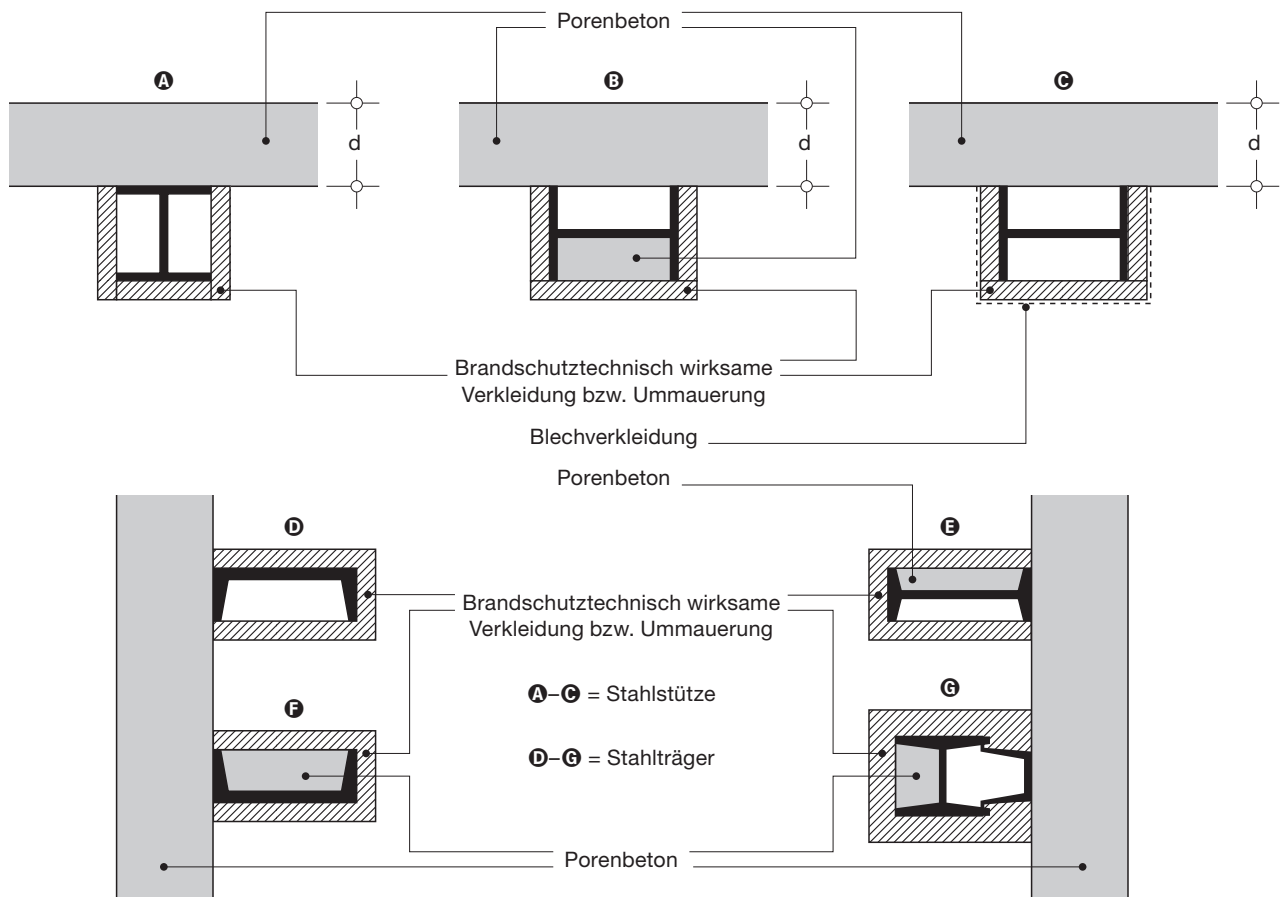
Anschlüsse von Brandwänden aus Porenbeton an Stahlbauteile, Beispiele nach EC 6
